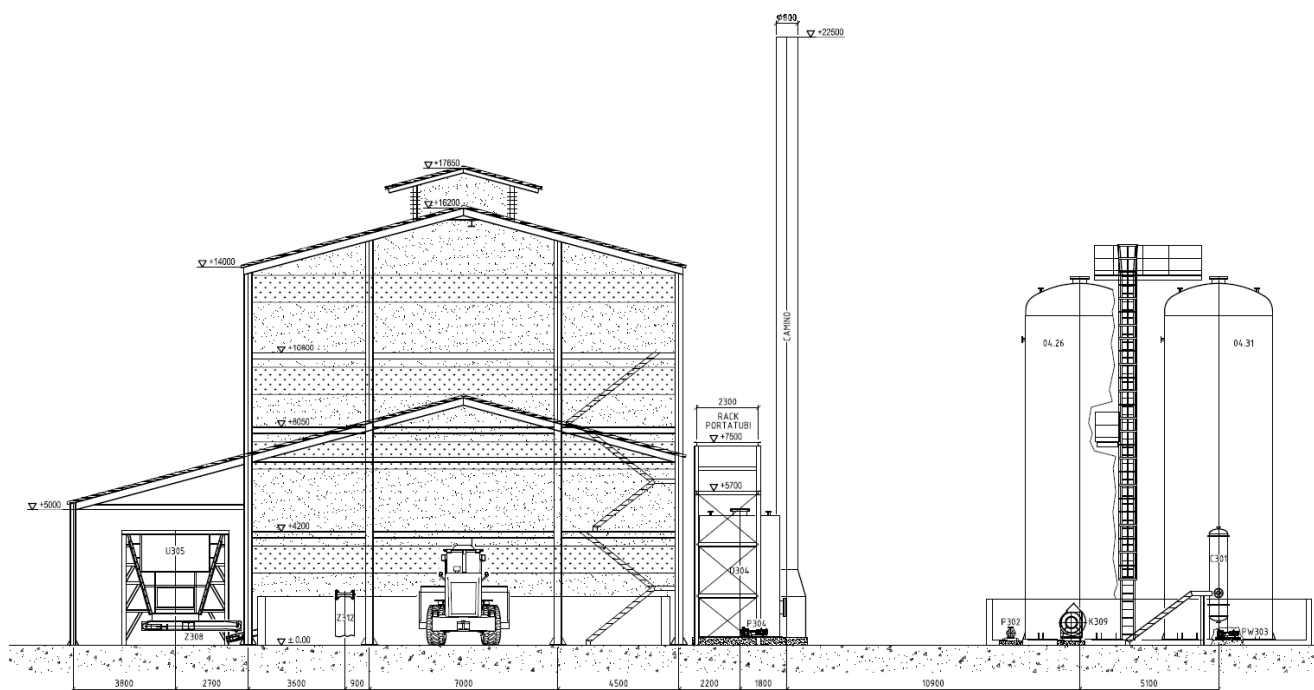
Prospetto trasversale del capannone, del rack e del bacino di stoccaggio.
